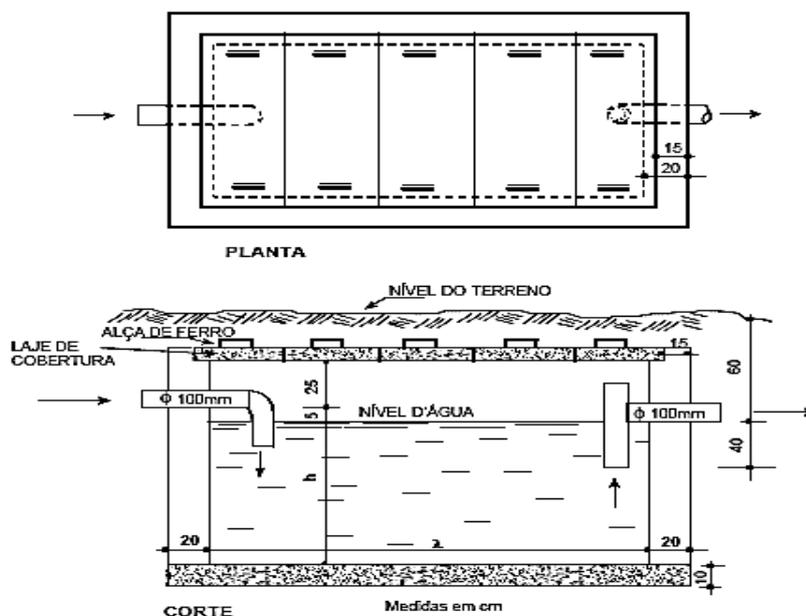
Vista em planta e corte de uma fossa séptica prismática retangular. Fonte: Quimilab (2008).
